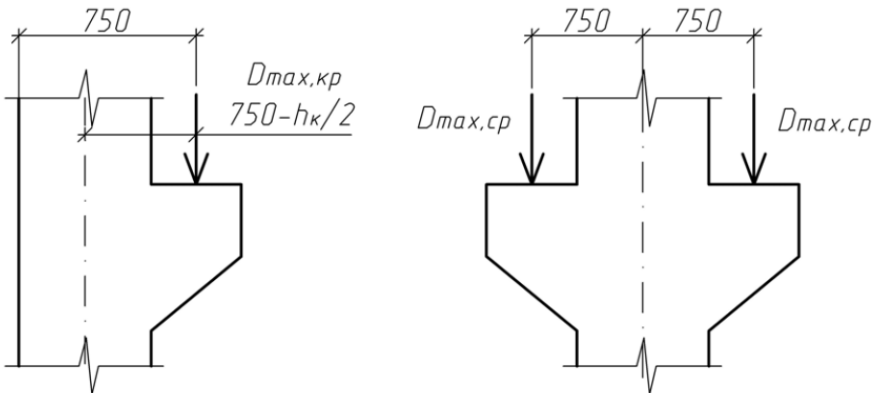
Схема прикладання вертикального кранового навантаження.
